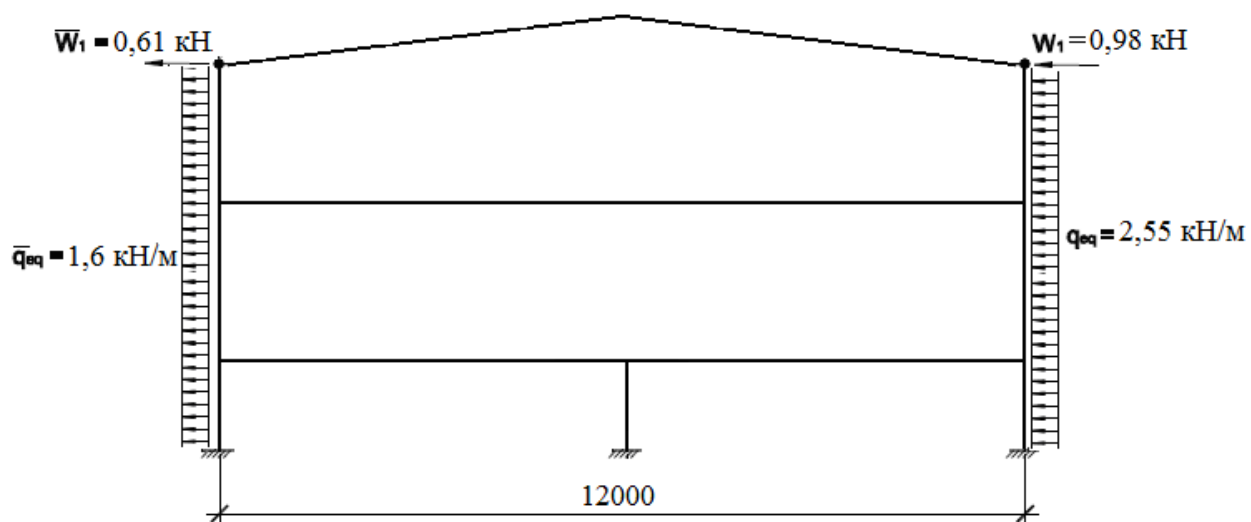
Схема загрузки от ветровой нагрузки справа здания
